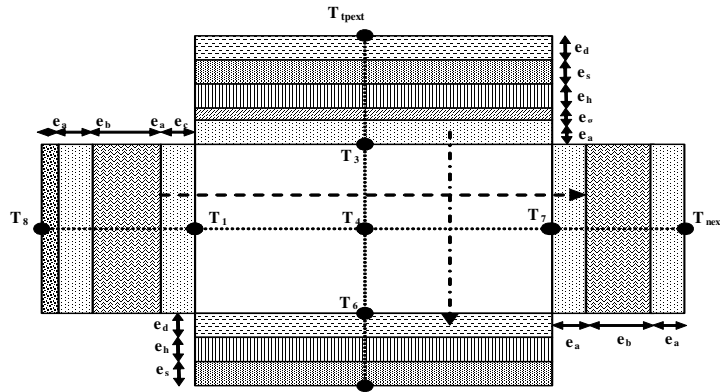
Coupe longitudinale pour l'identification des différentes couches.
